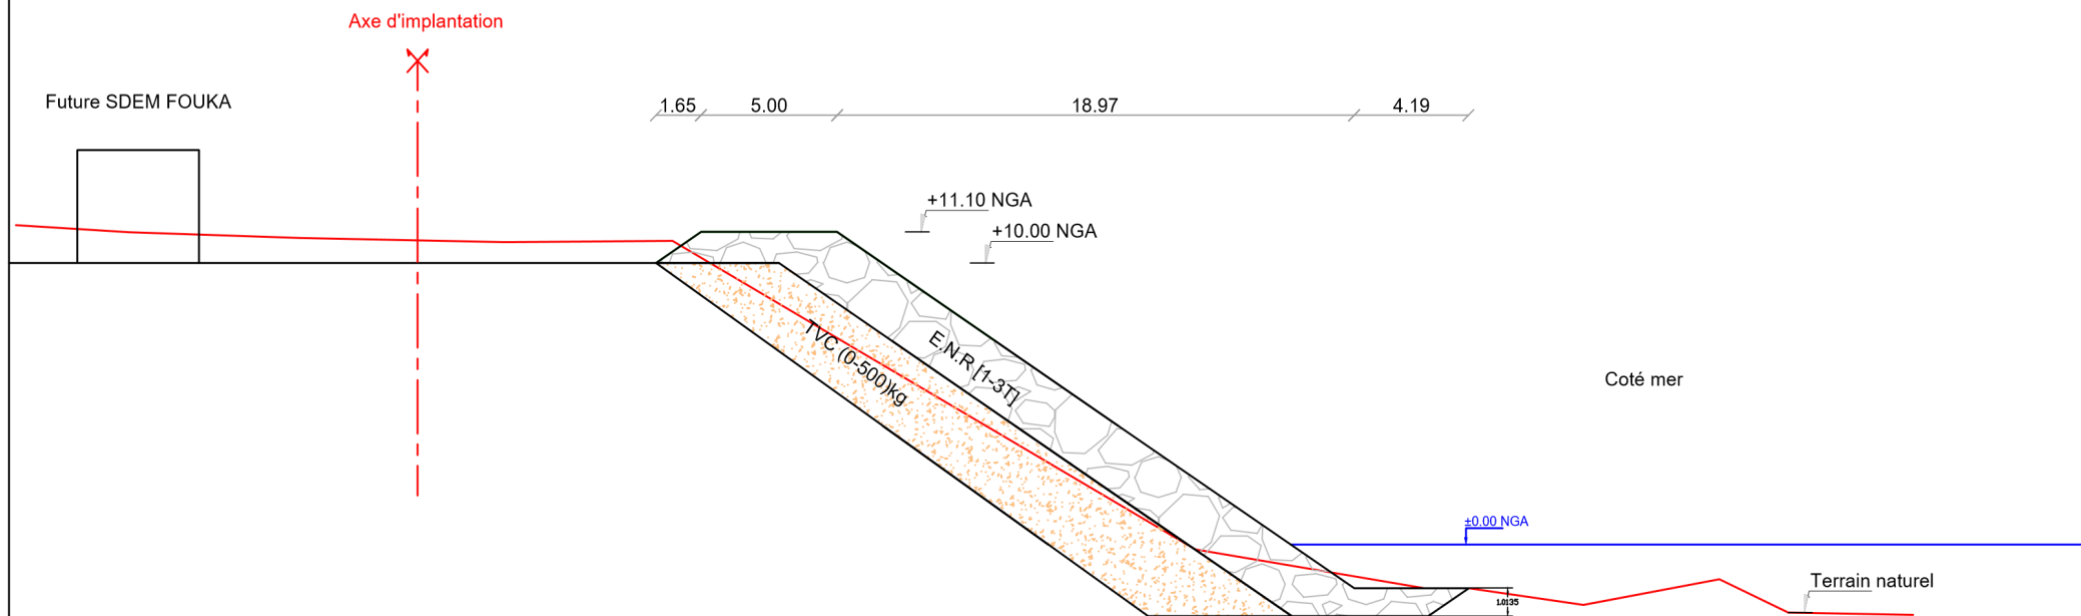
Protection frontale de la station de dessalement - Variante 01 Coupe- type 02
